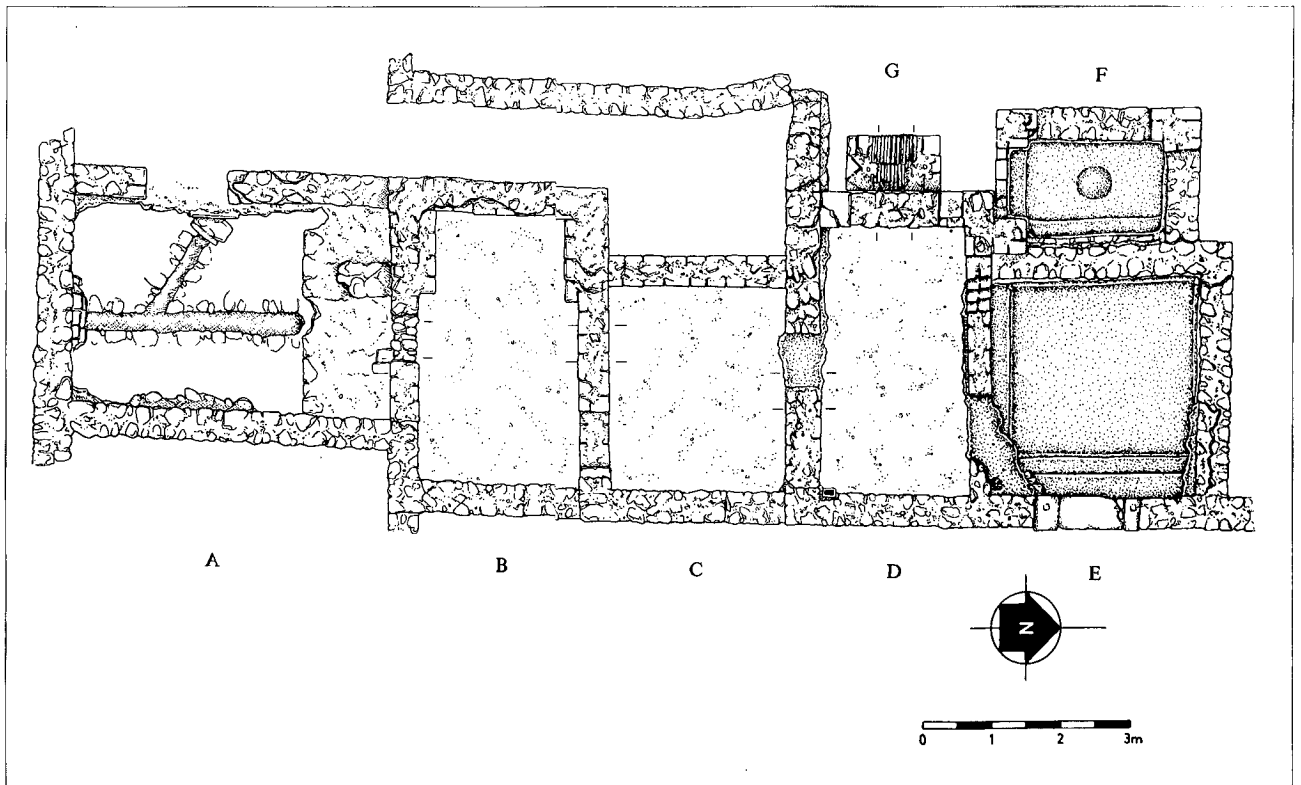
Planta del conjunt termal de la Vila dels Ametllers.
